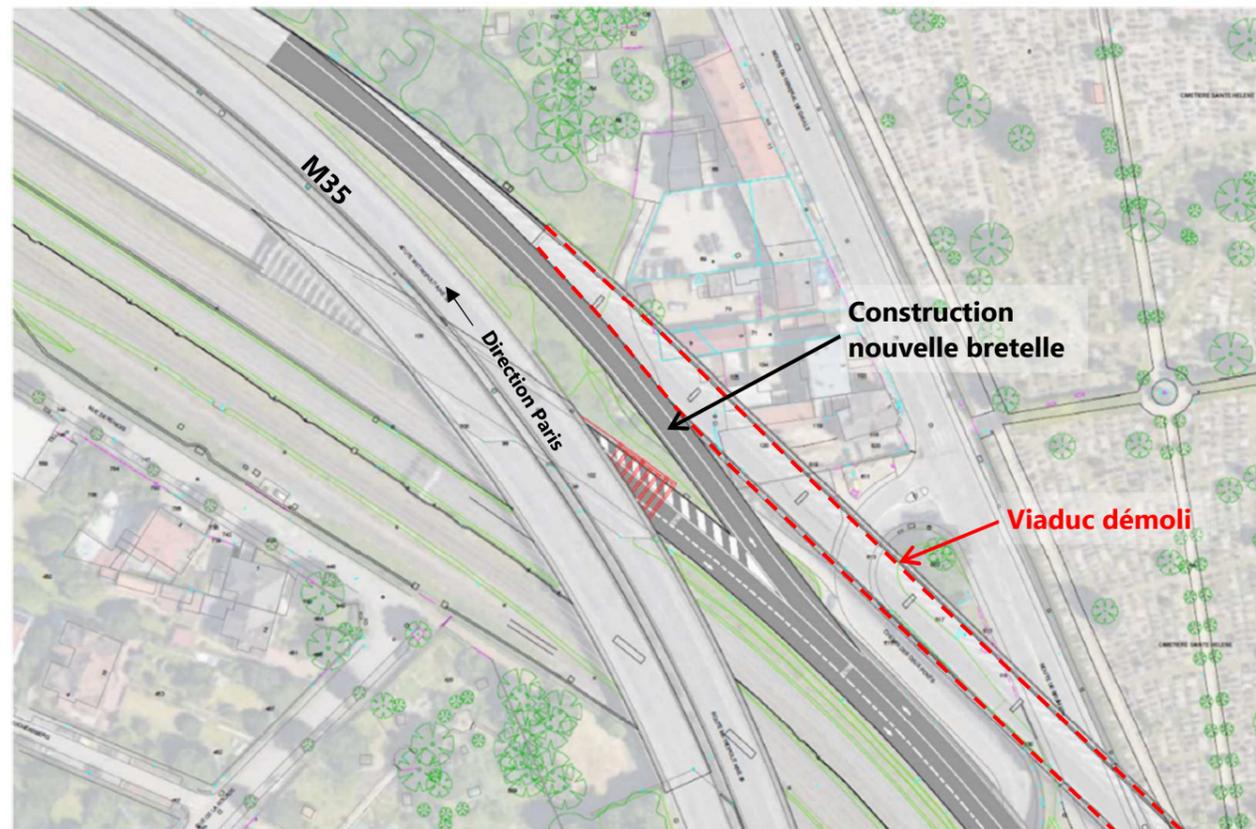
Plan de la nouvelle bretelle d'accès à la M35
